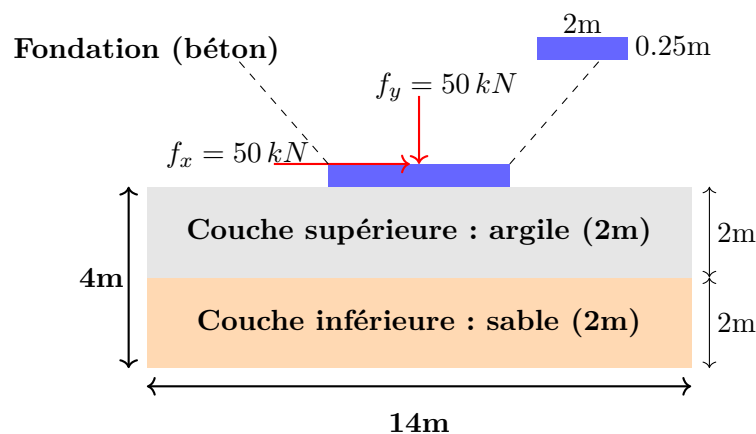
Schéma de la semelle sur sol bicouche (argile + sable)
